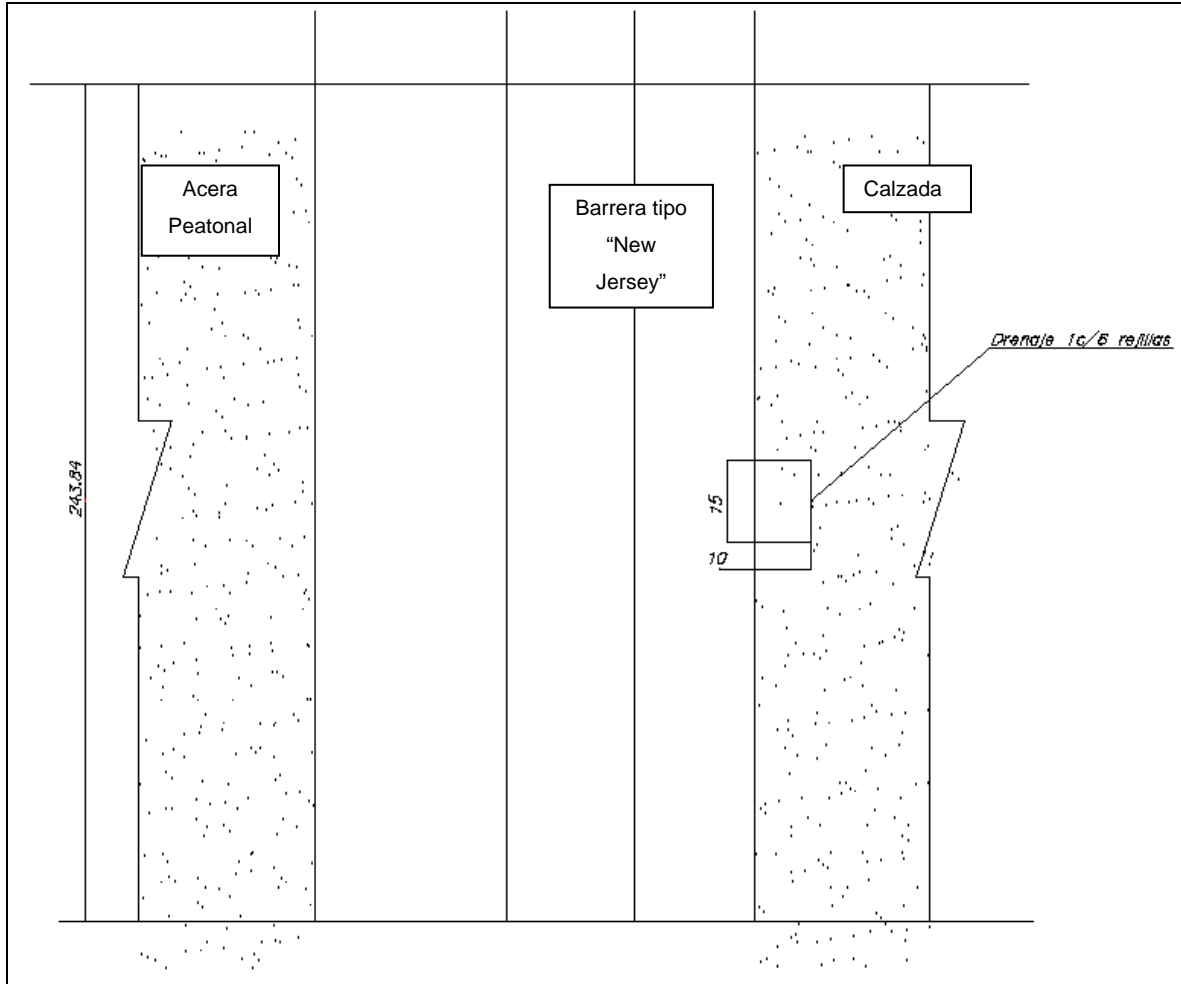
Detalle de los drenajes en planos. Vista de planta.
